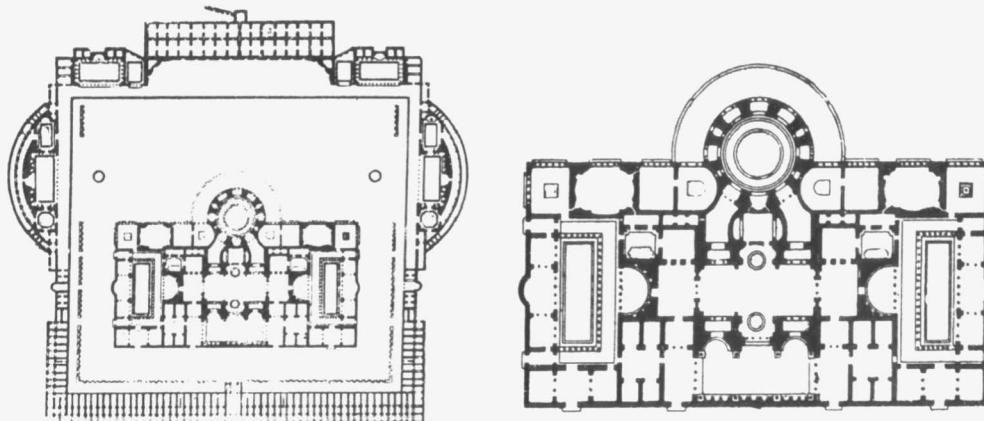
古罗马卡拉卡拉浴场总平面及主体建筑平面
